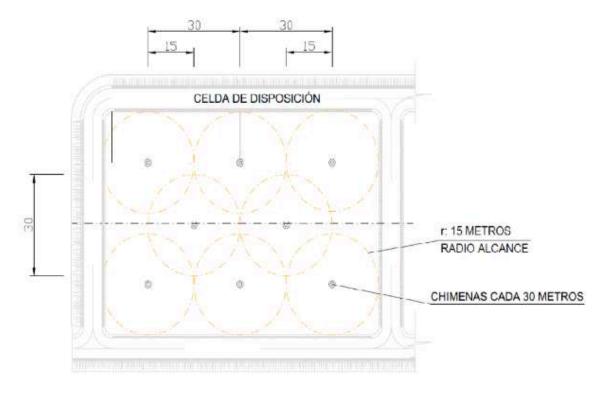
Detalle típico ubicación chimeneas de venteo pasivo
